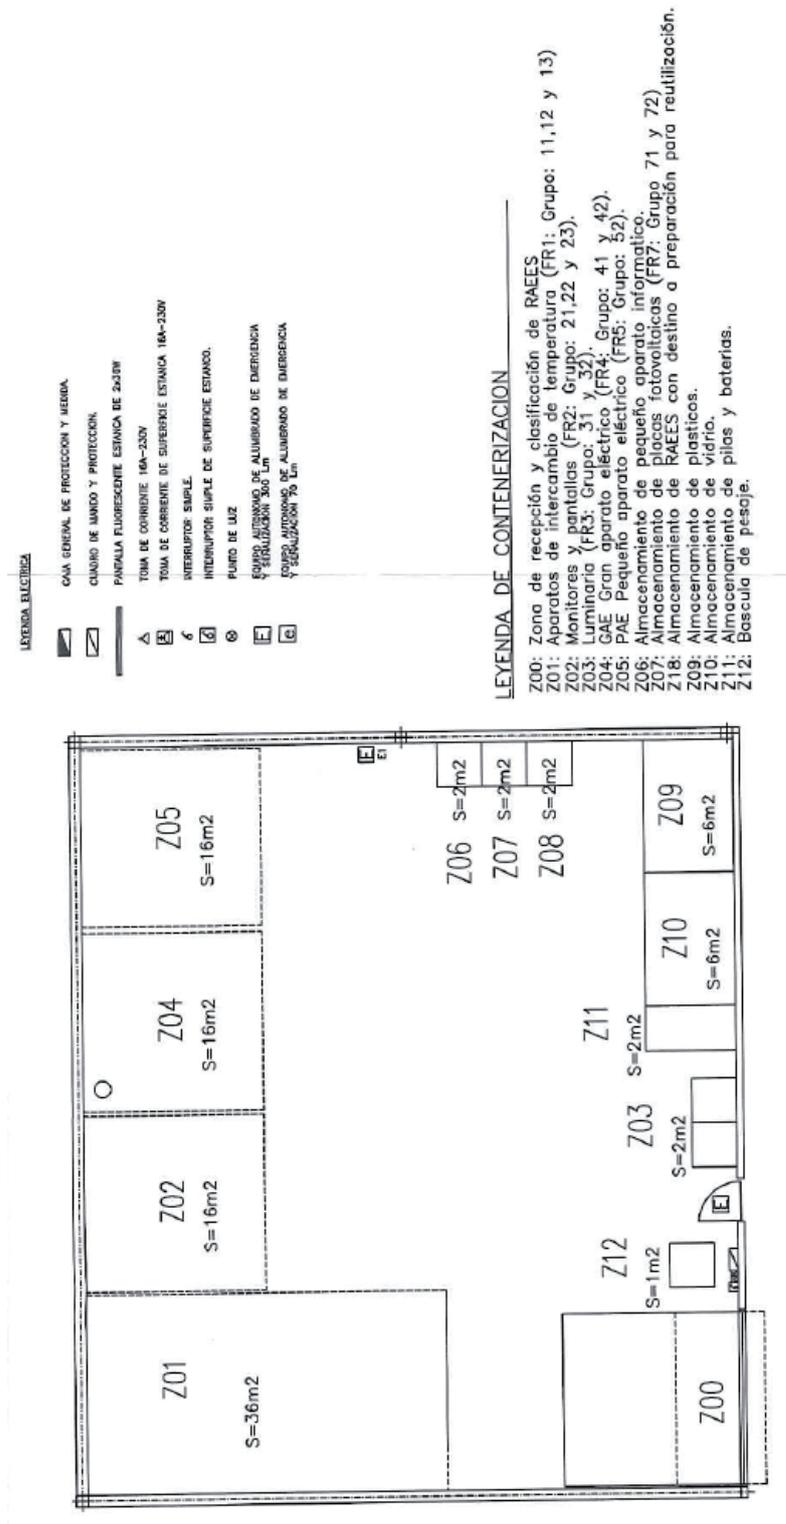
Plano en planta de la nave 10. Distribución de los residuos.
